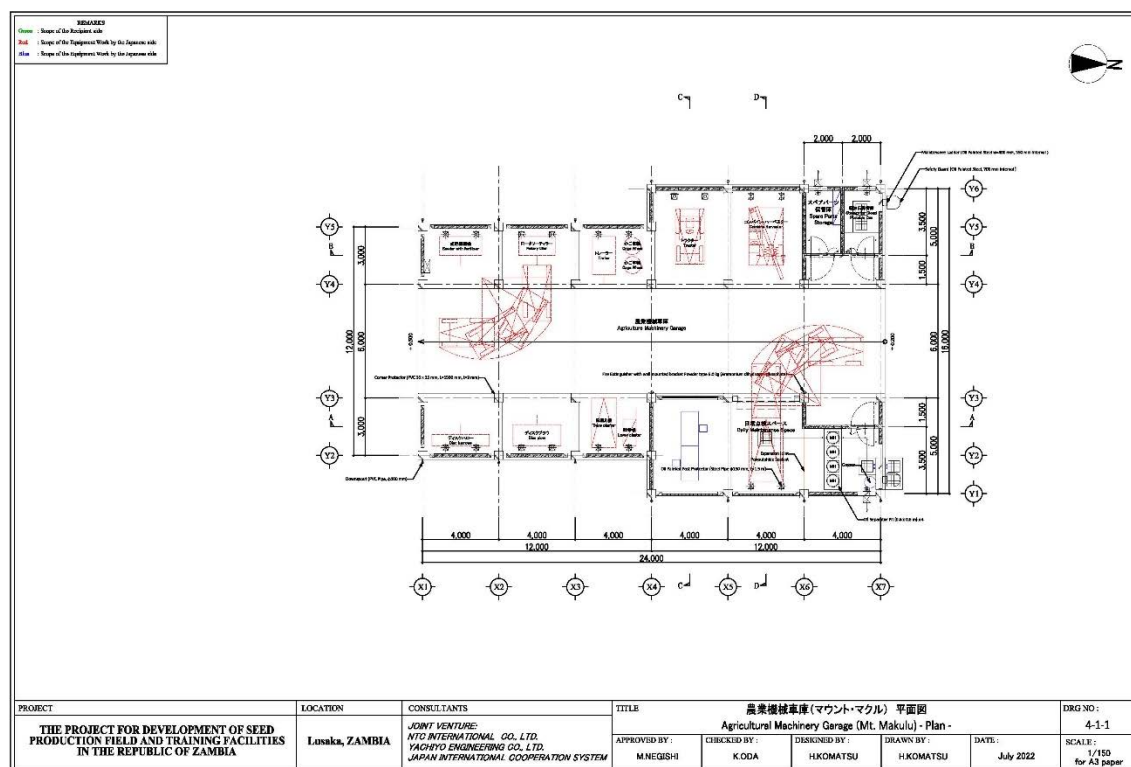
農業機械車庫の平面図(マウント・マクル研究所)
